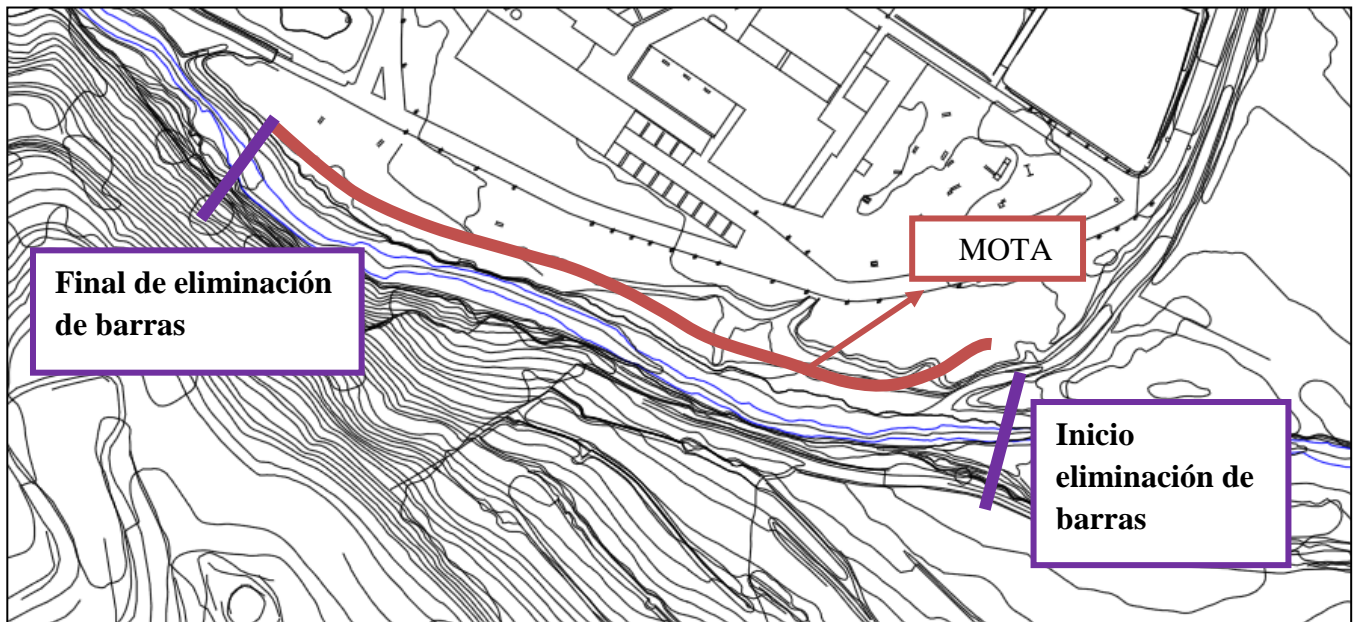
Esquema en planta de las actuaciones para la alternativa 1
